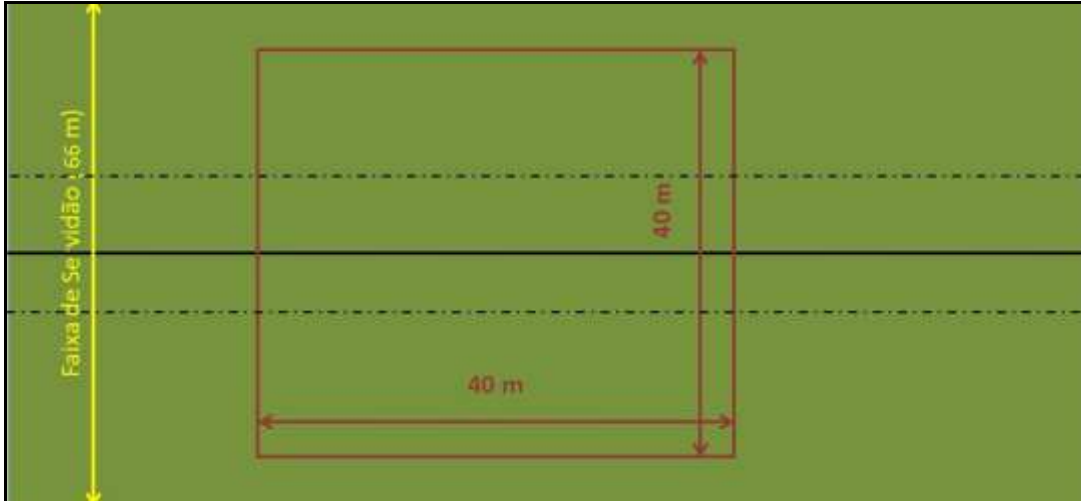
Croqui de supressão para implantação de torre autoportante.
